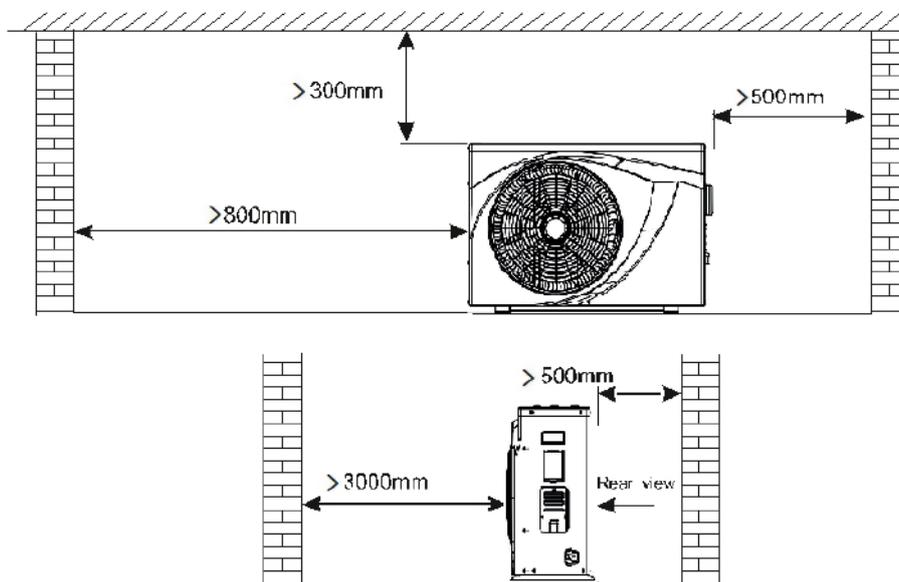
Requisiti di spazi di installazione orizzontale (mm)
